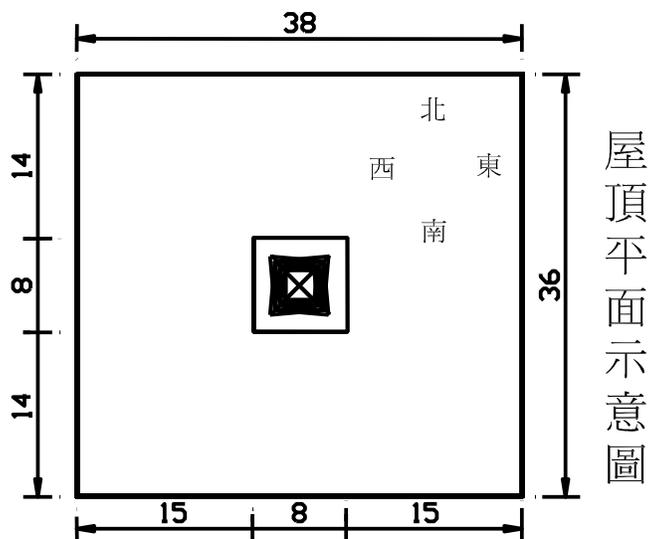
建築物屋頂平面示意圖 單位 (m)
